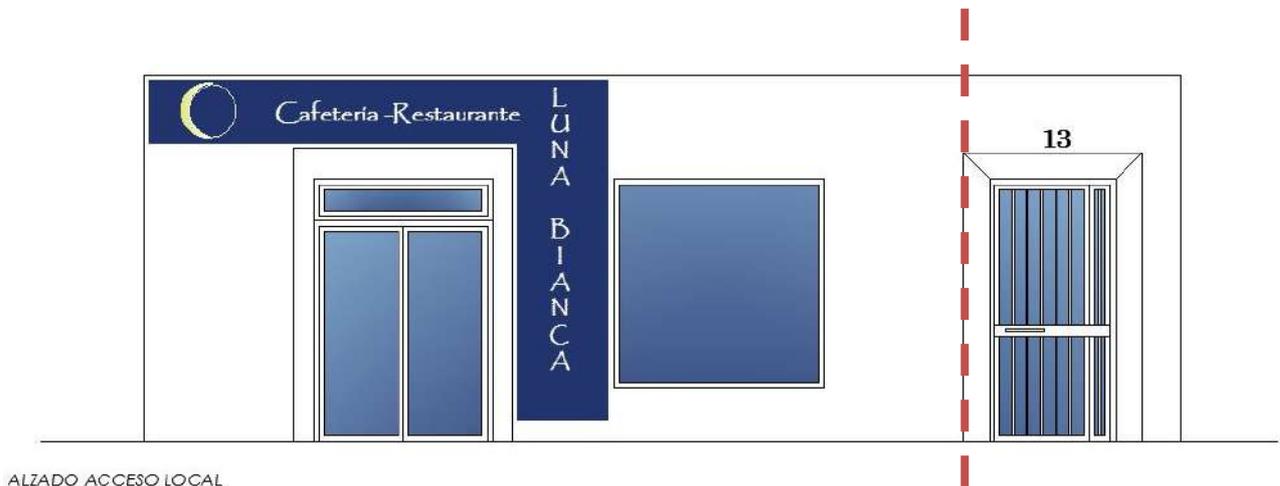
Alzado propuesto – Fuente: Creación propia
